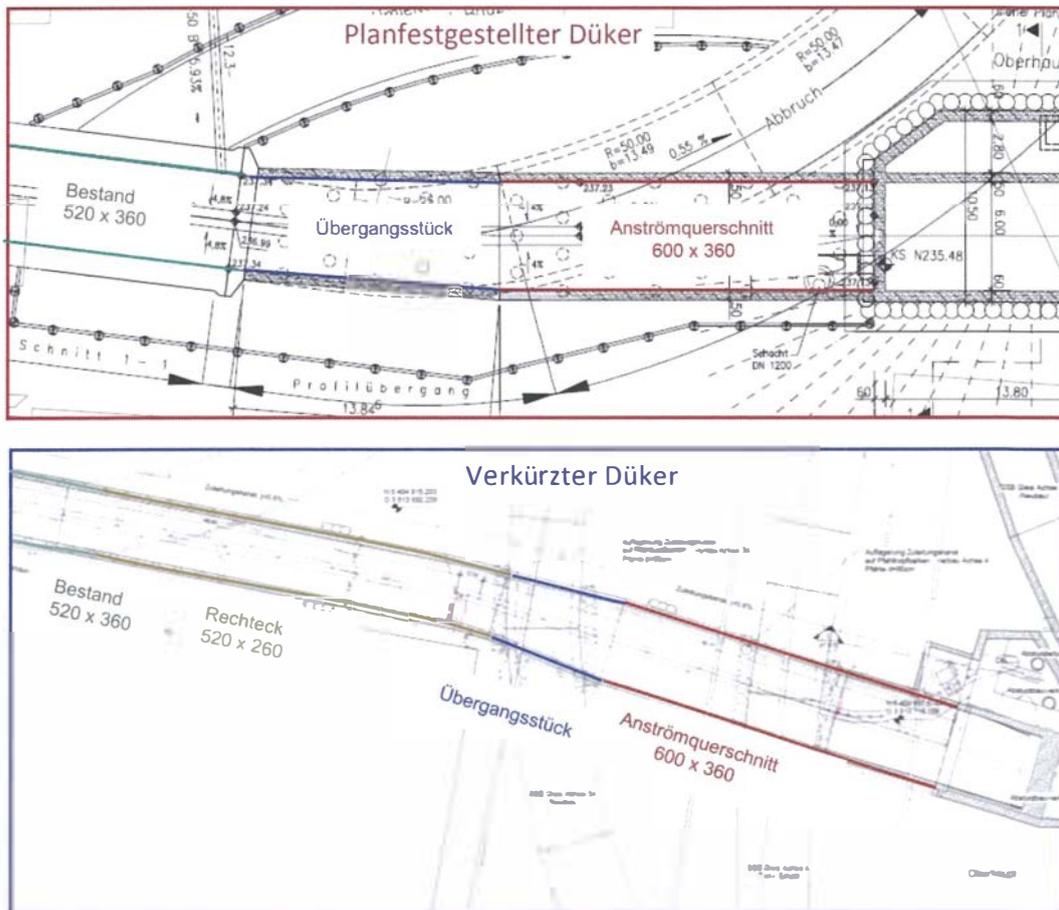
Grundriss Zulaufgerinne / Anströmung Oberhaupt
